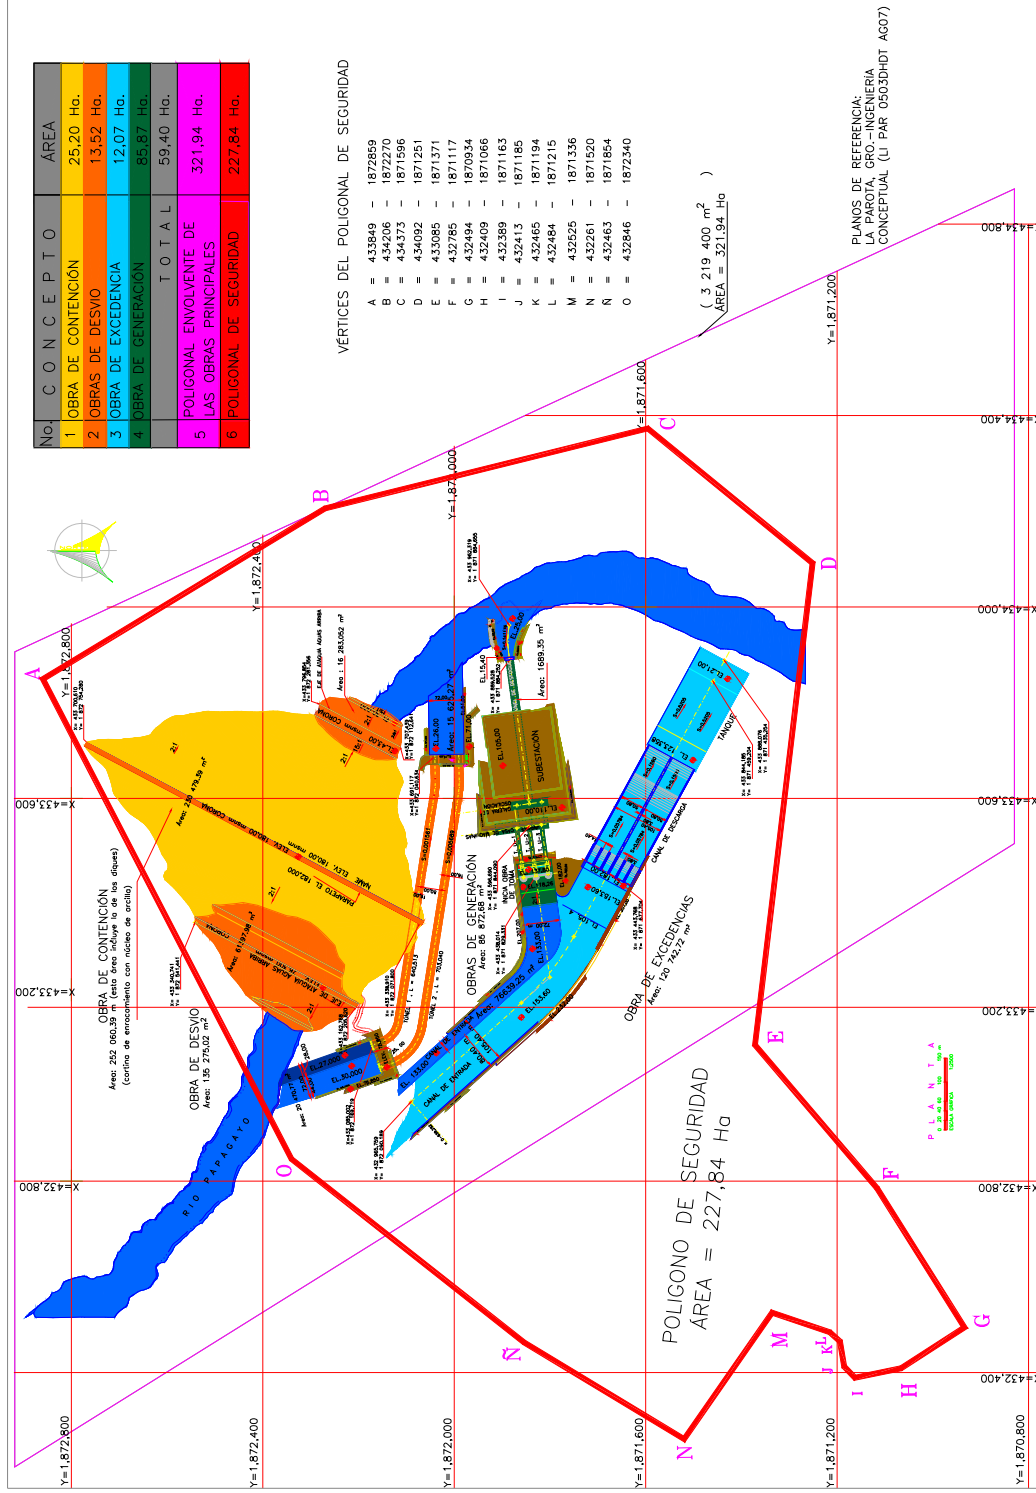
Arreglo general de las obras principales (ampliar imagen para ver detalle)
